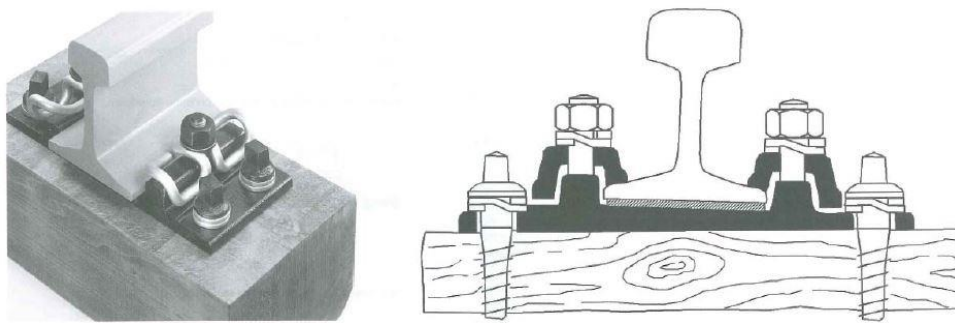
Fixações indiretas Vossloh KS e “K” em travessa de madeira (Fonte: (17))
